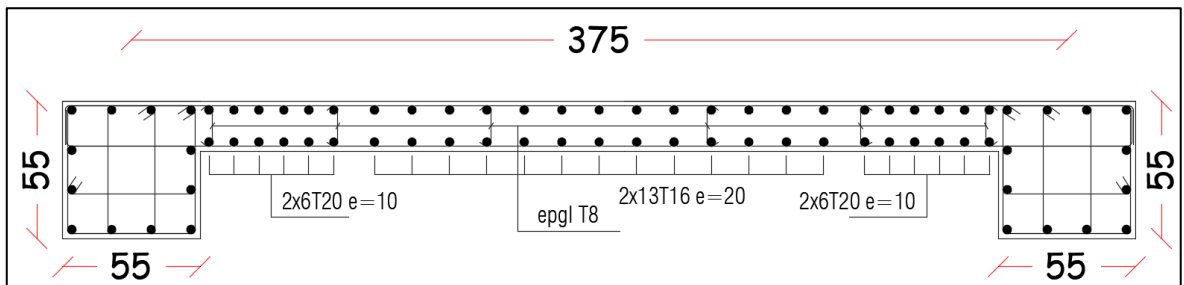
Exemple de ferrailage du voile RDC (L= 3,20 m)
